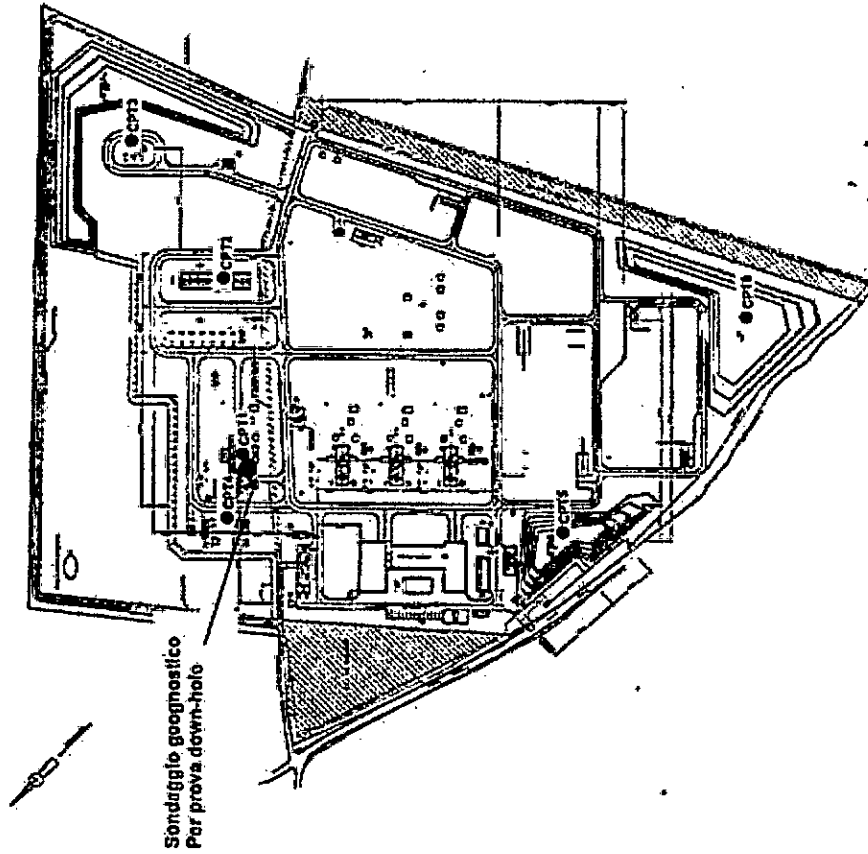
planimetria ubicazione prova penetrometriche statiche.
